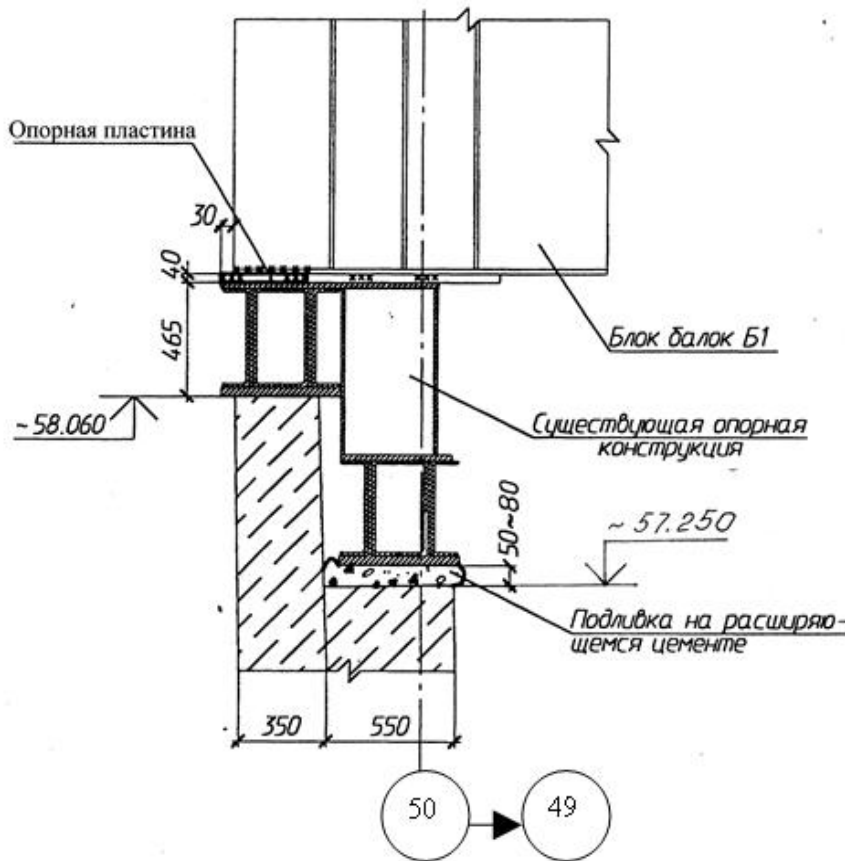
Усиление опорных частей балок Б1 и металлической опоры под балки Б1 в месте опирания блока балок Б1 на железобетонную стену по оси 50 (ряд П).
